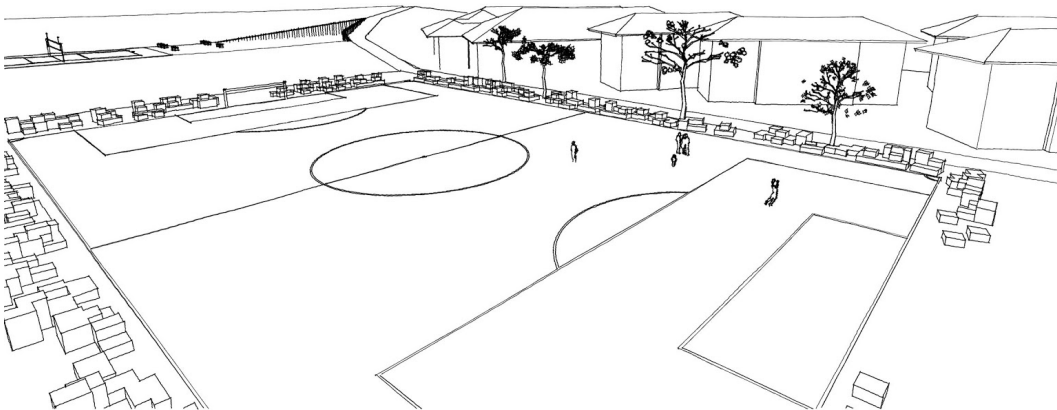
Perspectiva das primeiras propostas de implantação da arquibancada modular.
